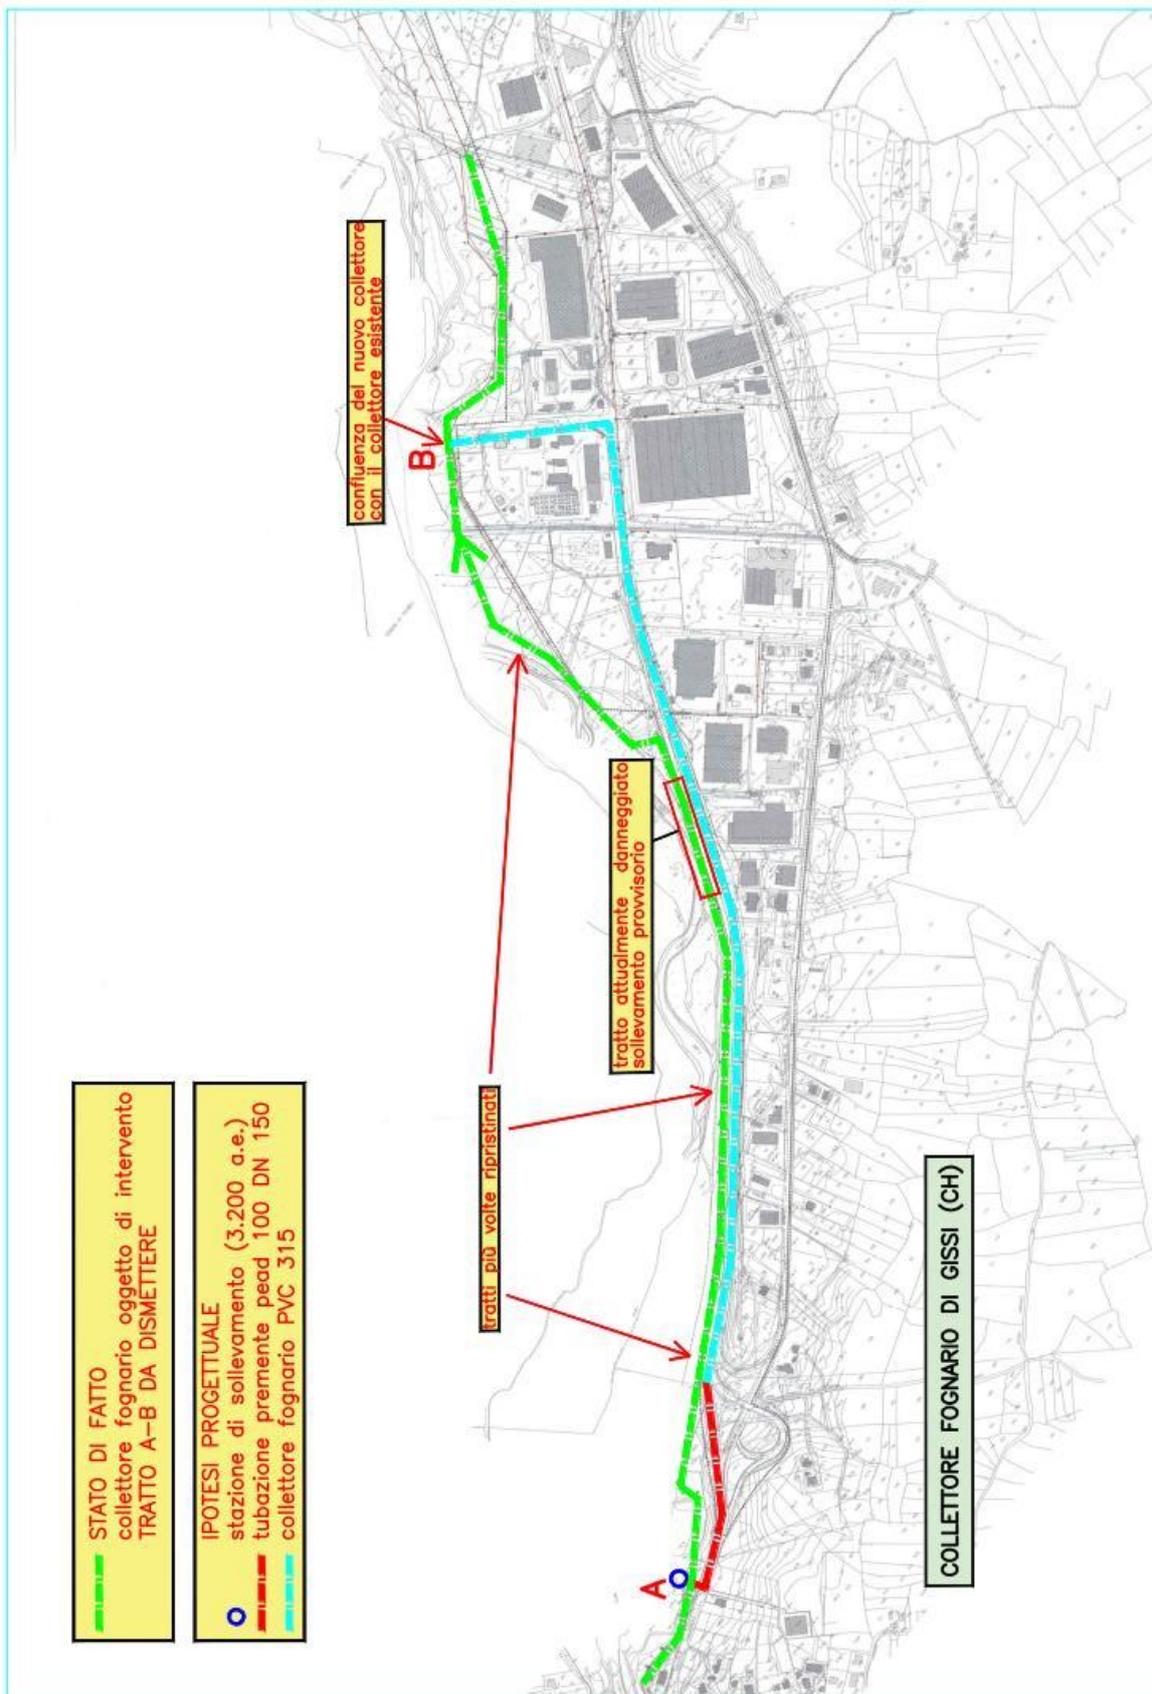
schema planimetrico della fognatura di Gissi con indicazione del tratto AB da sostituire
